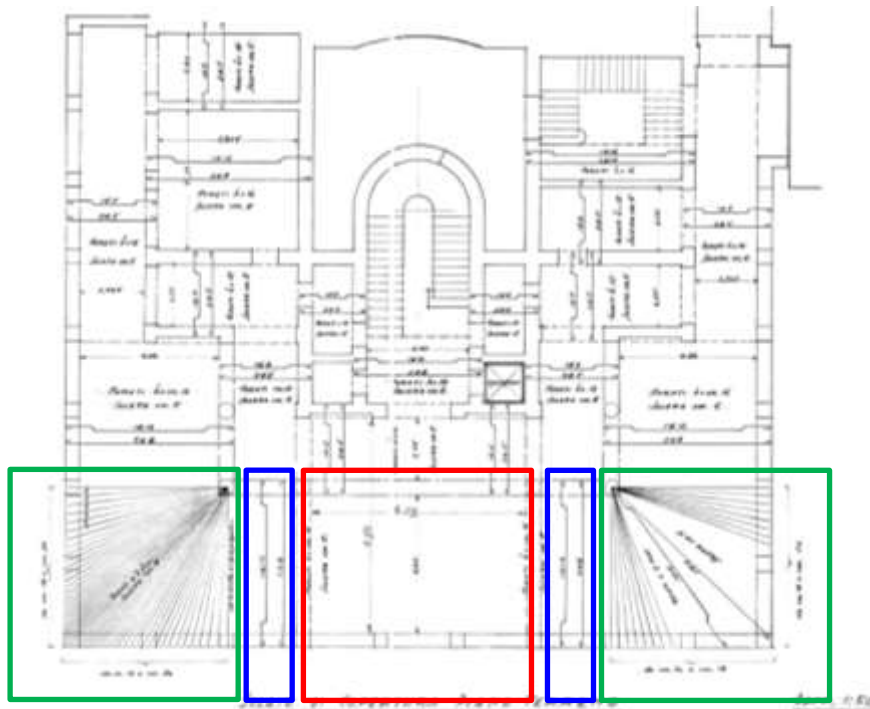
Solaio tra piano terra e piano primo: indicazione delle orditure e delle armature presenti, progetto preliminare
